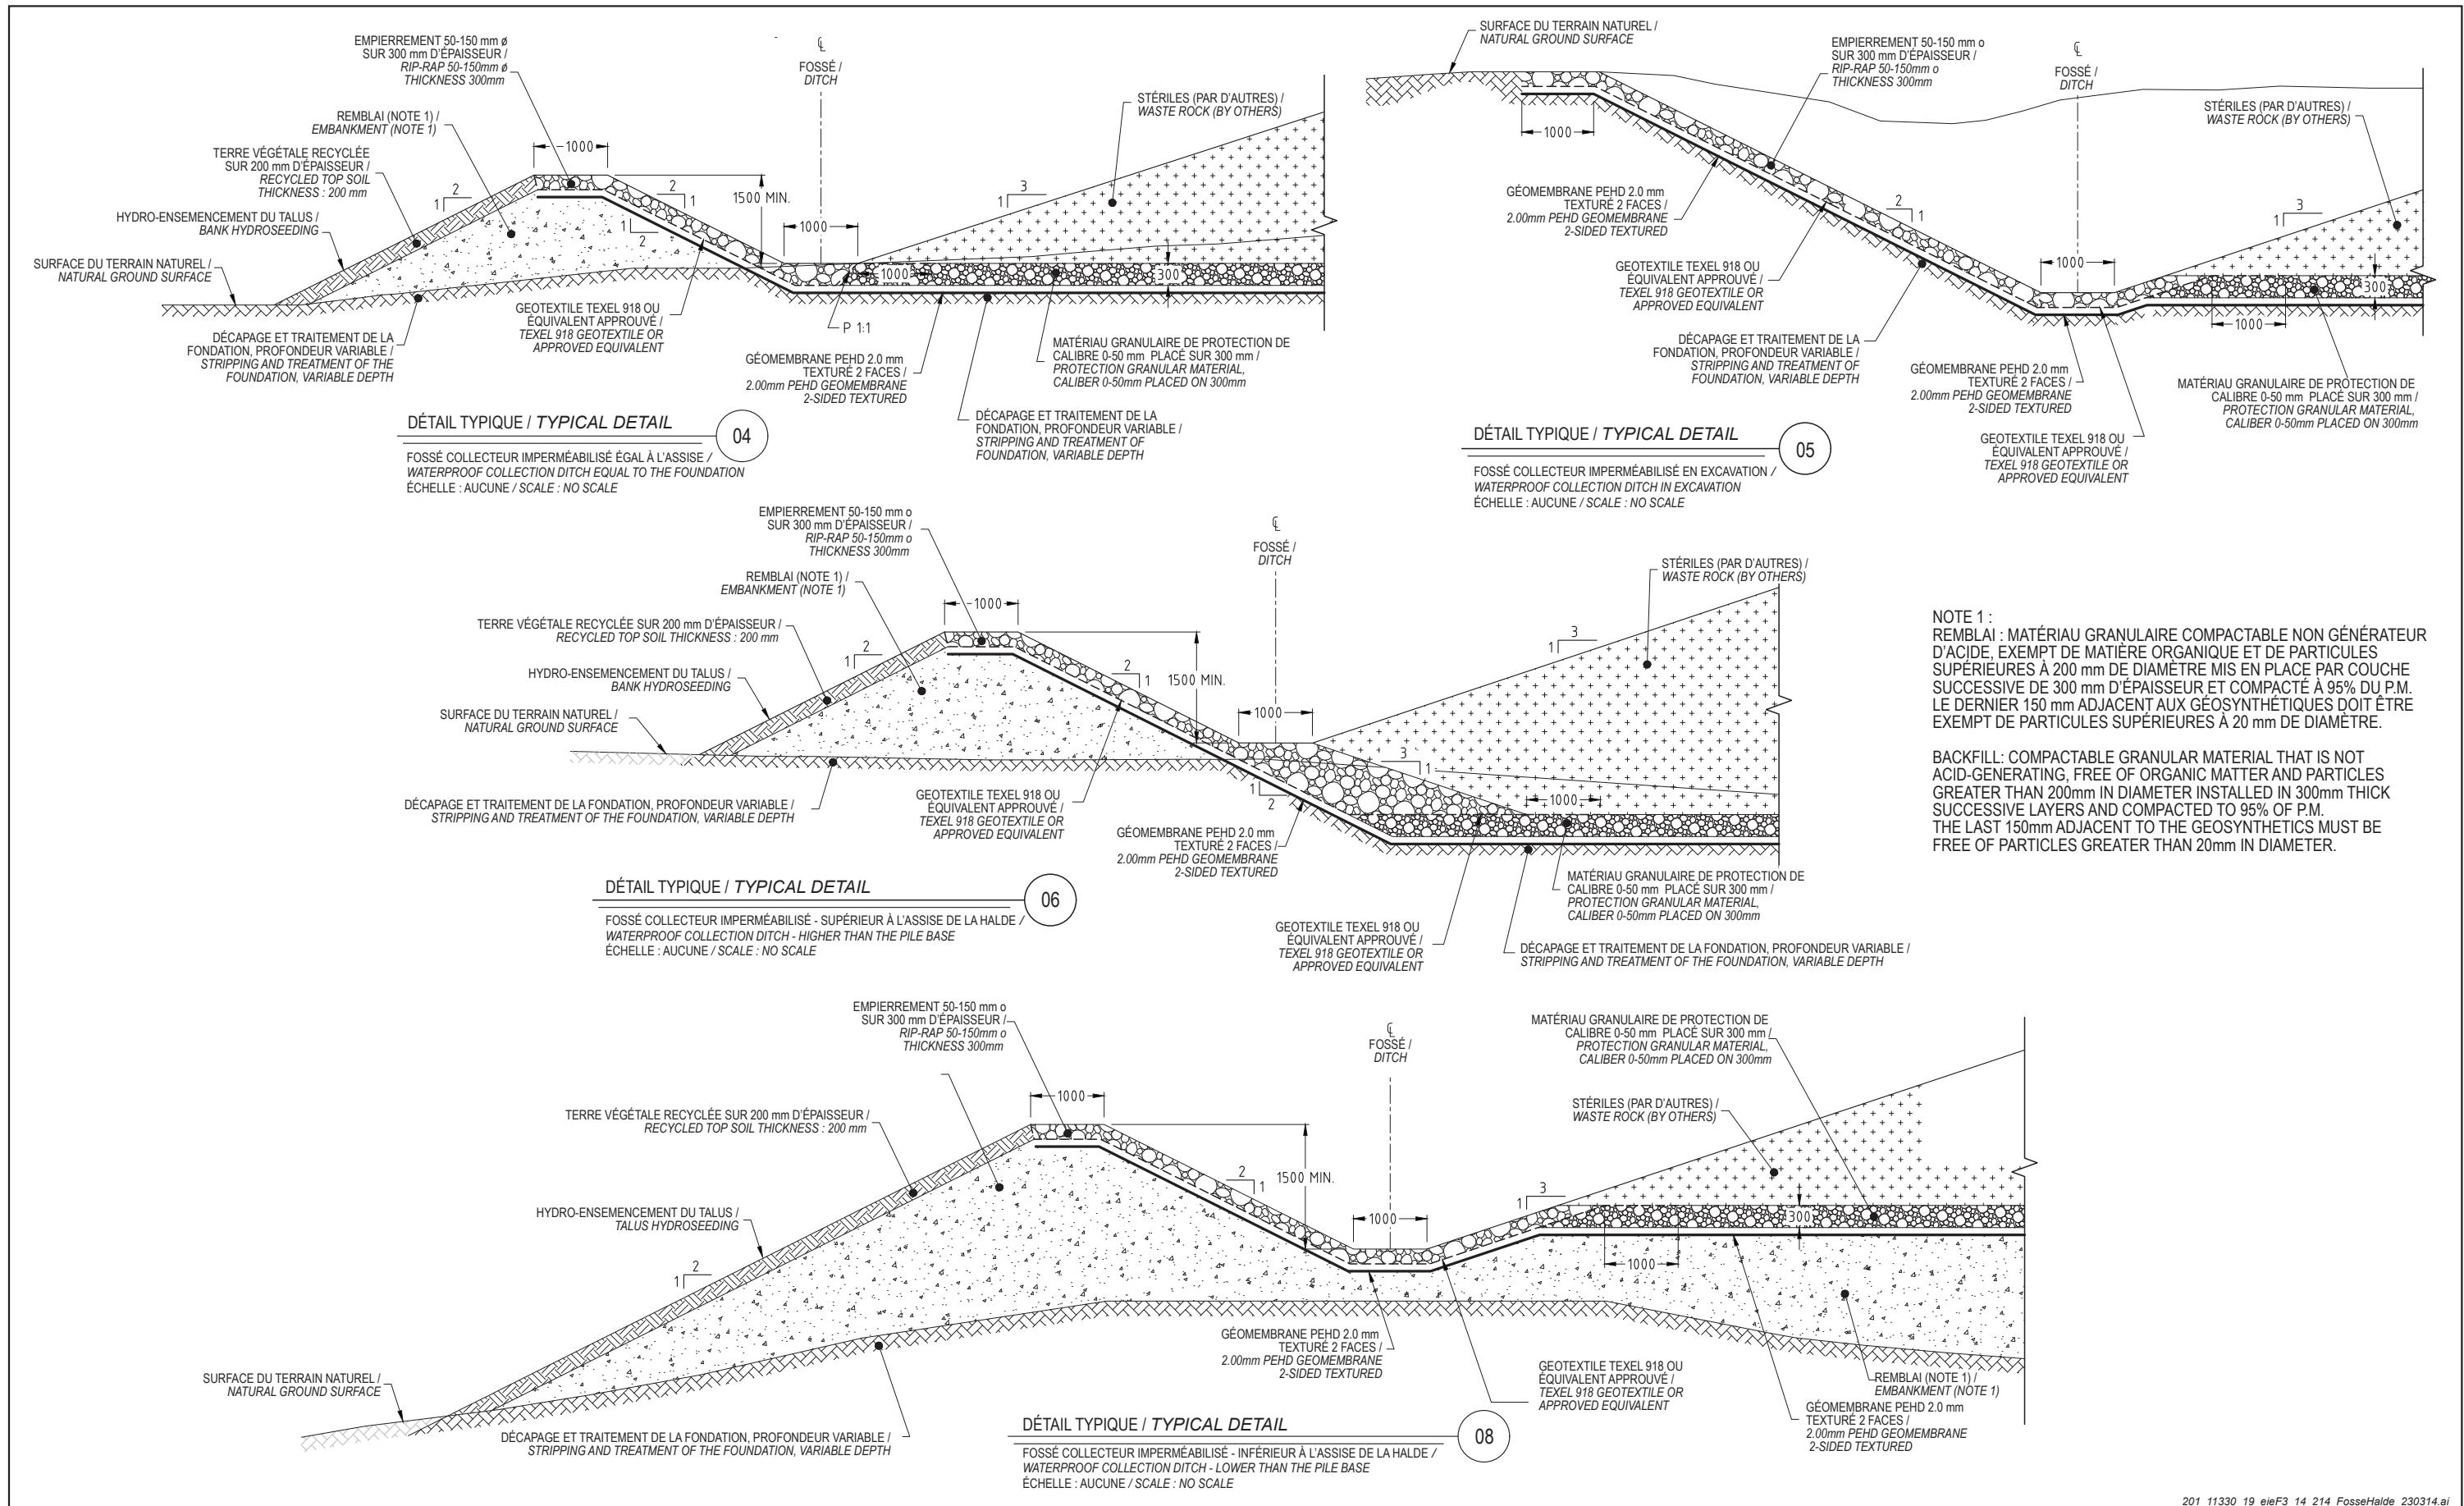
Coupe-type des fossés collecteurs de la halde à stériles / Waste Rock Stockpile Collection Ditch Typical Cross-Section (réf. Modifié du plan émis par WPS pour Osislo (515-C-0601-ZA))
